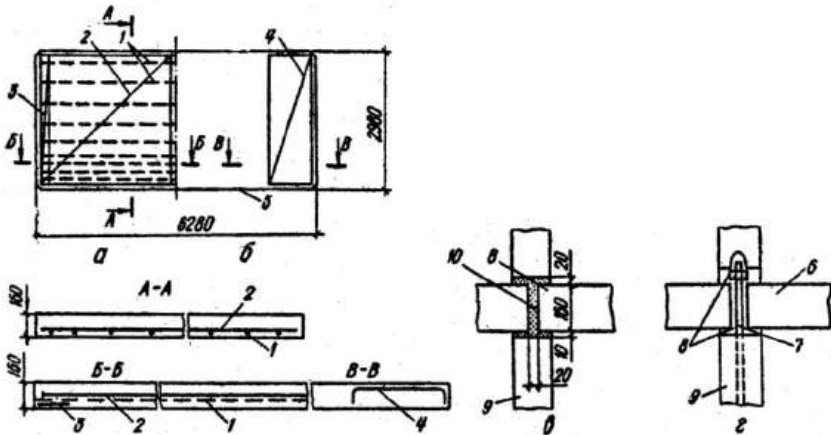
Загальний вигляд залізобетонної суцільної плити перекриття, опертої на три сторони: *а* – нижня арматура; *б* – верхня арматура; *в* – платформовий стик суцільних плит та панелей внутрішніх стін; *г* – удосконалений платформовий стик тих самих елементів; *1* – напружувана стержнева арматура; *2* – нижня сітка; *3* – сітка підсилення зони анкерування попередньо напруженої арматури; *4* – верхня сітка; *5* – вільний край; *б* – суцільні плити перекриттів; *7* – штир-фіксатор із гайкою та шайбою; *8* – шви зі спеціальної пасти; *9* – панелі внутрішніх стін; *10* – шви з цементного розчину
